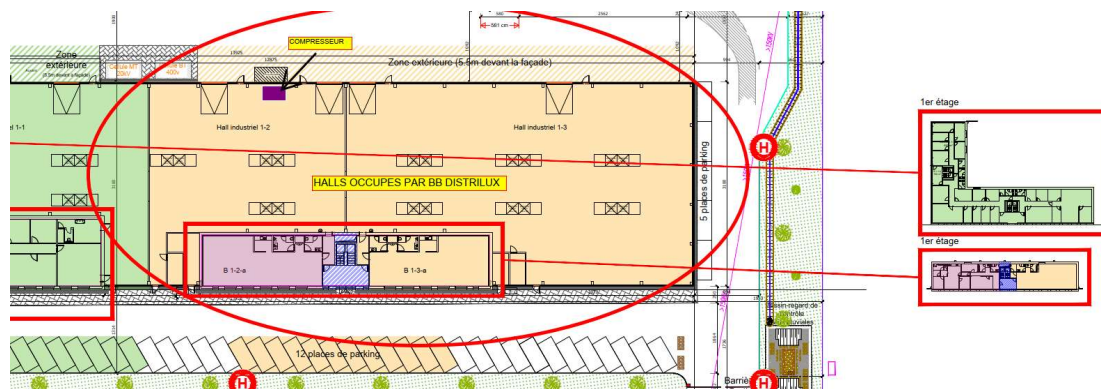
Implantation de BB DISTRILUX (secteur jaune) sur le site SISA, détail du hall 1 (Source : SISA FOETZ).
